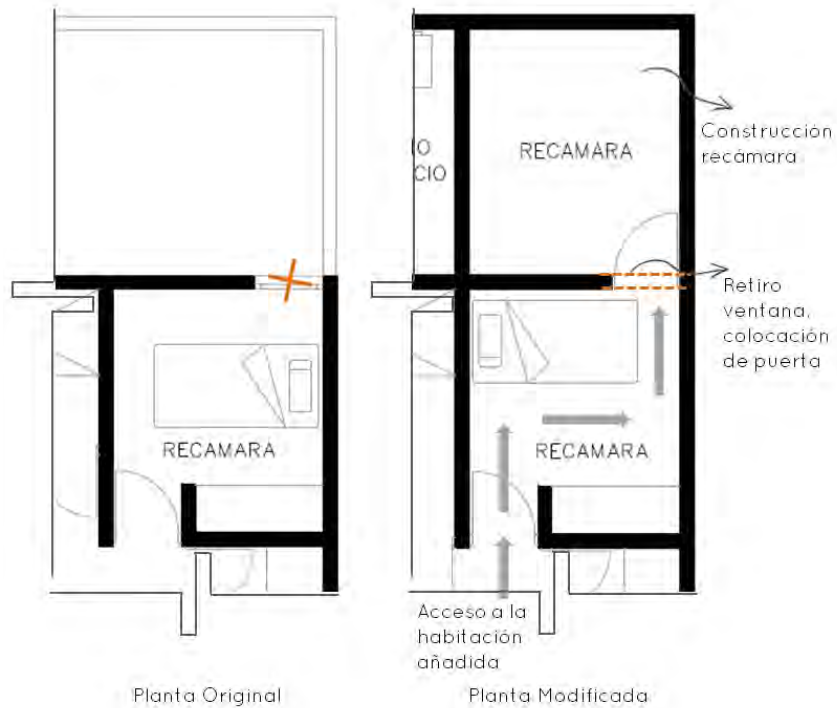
Planta actual comparada con la original, indicando las modificaciones que presentan los espacios
